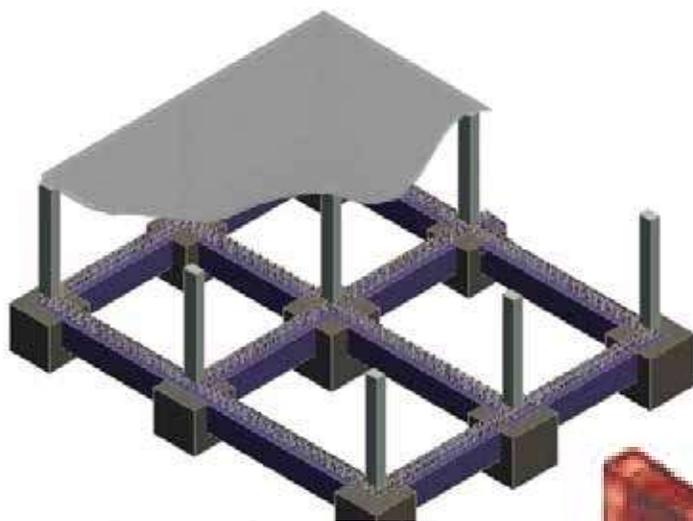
Estructura de Concreto Armado/Elaborado por LAS
